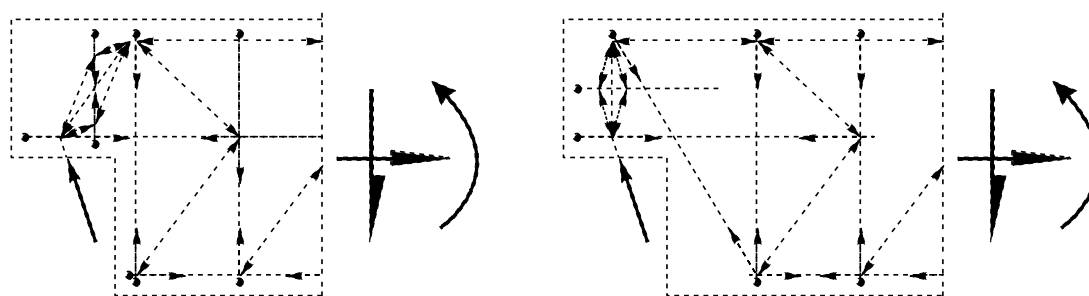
Расчетные модели для проектирования армирования подрезок
